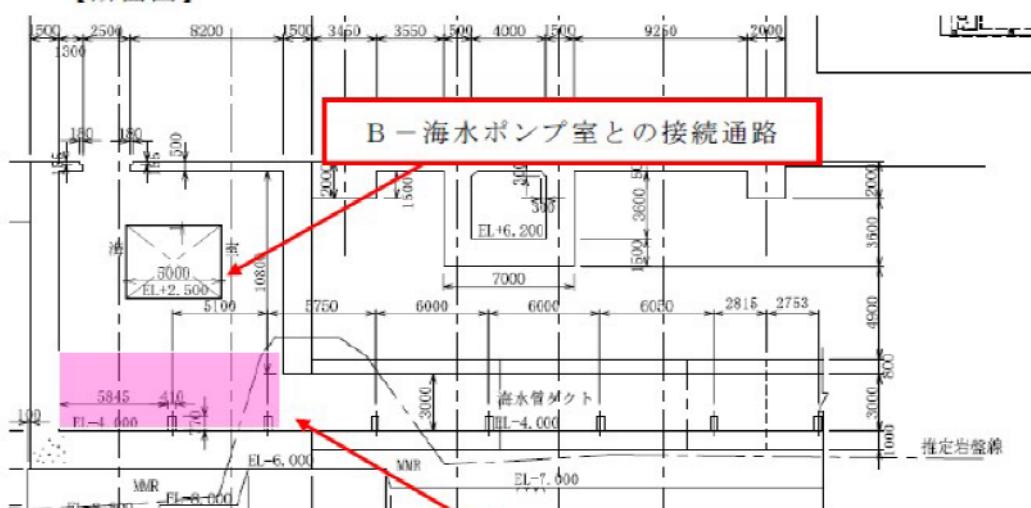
原子炉補機冷却海水管ダクト平面図及び断面図
